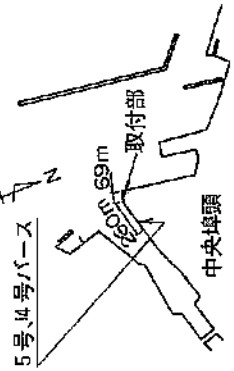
エプロンクラック平面図 (中央埠頭地区, ④岸壁(7.5m))
